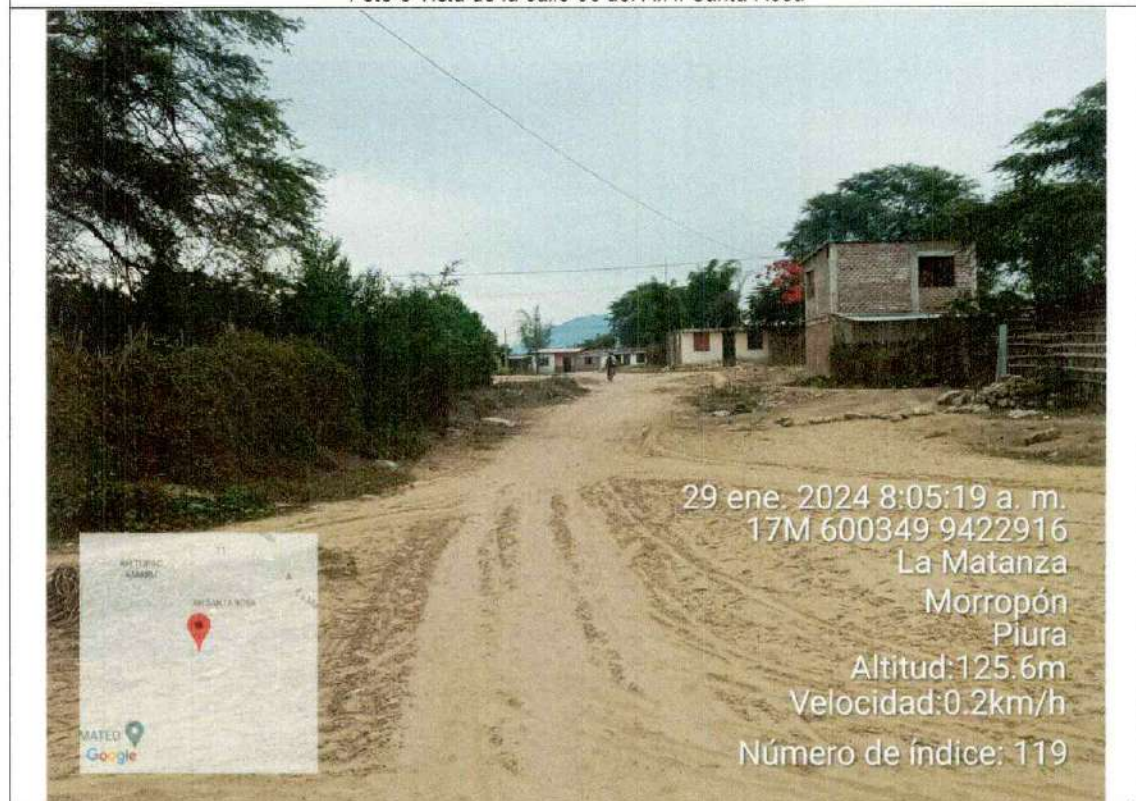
Vista de la calle 07 del A.H. Santa Rosa
